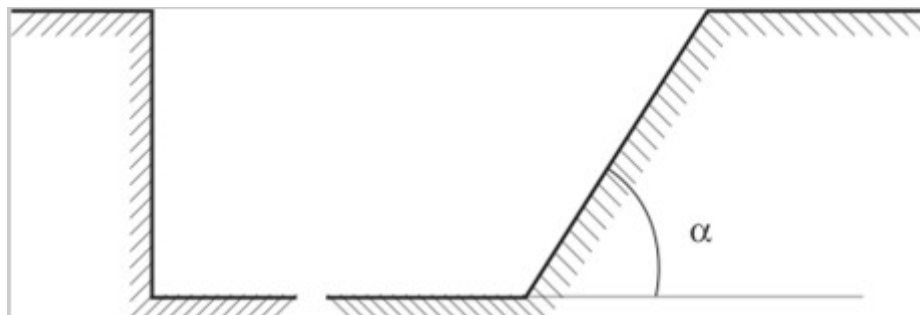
Вертикальные и откосные стенки котлована или траншеи
